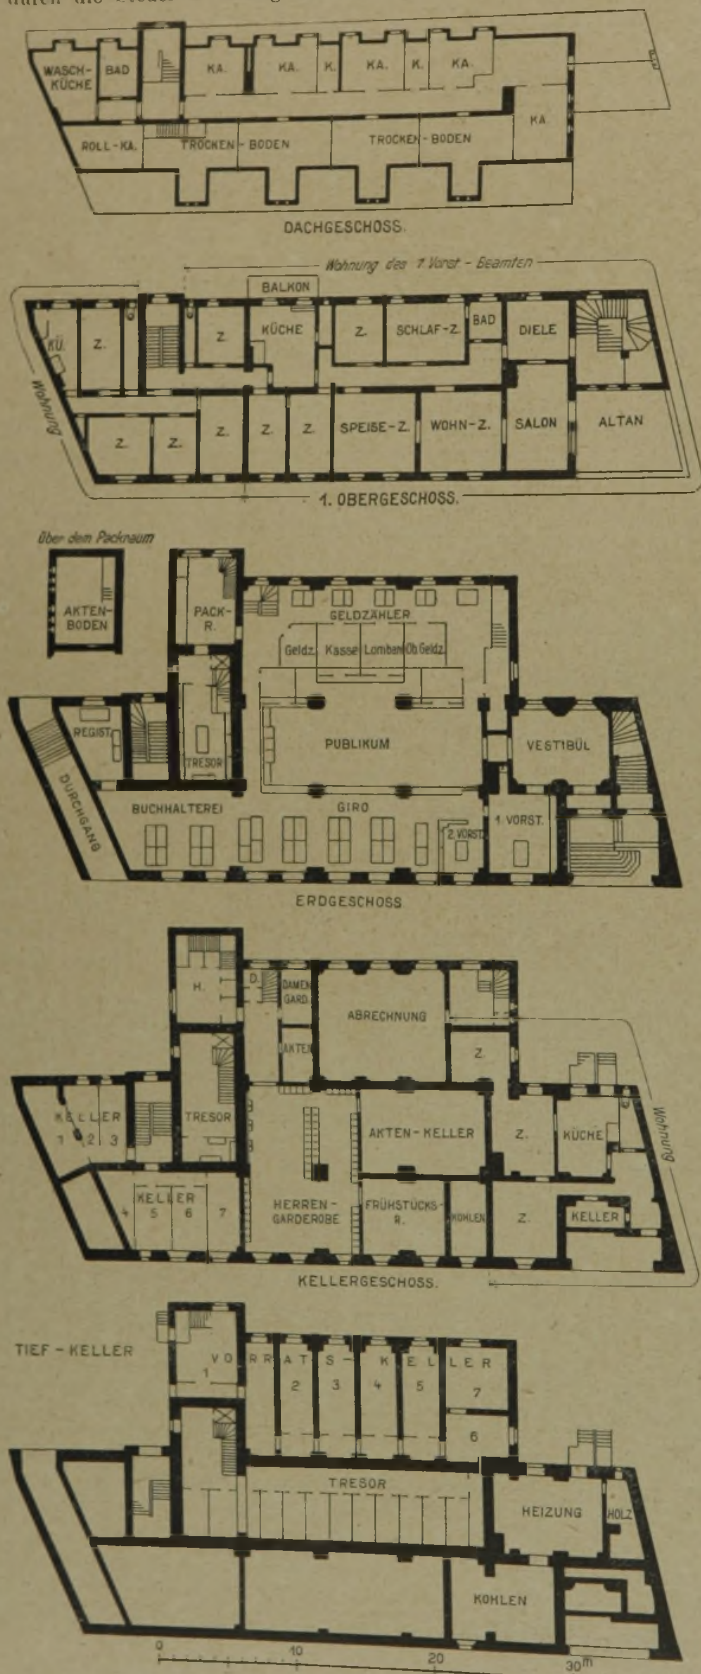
Grundrisse des Bankgebäudes.
